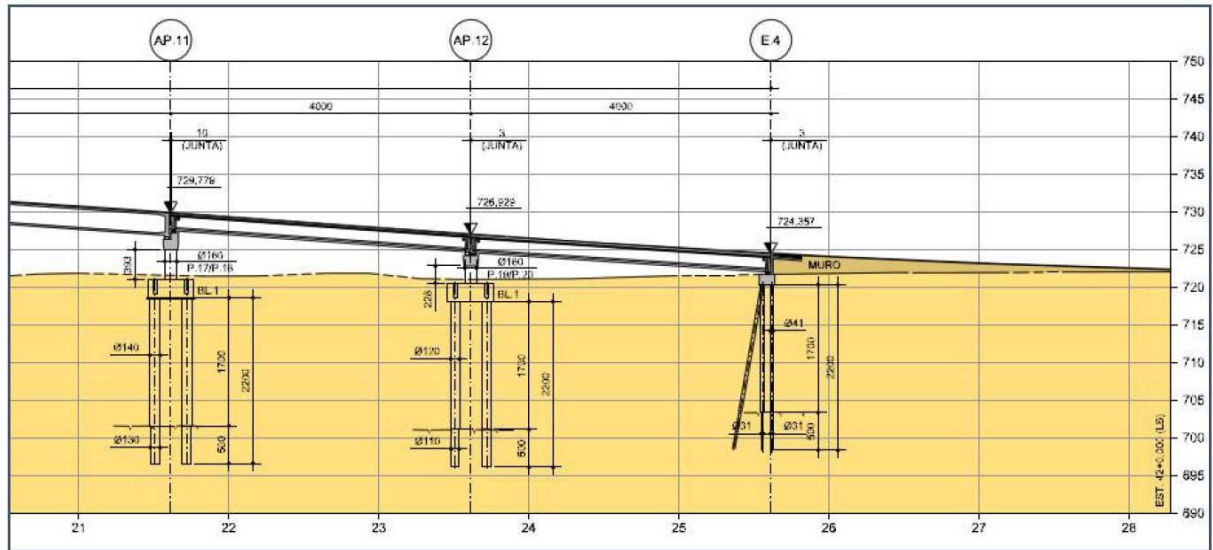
Perfil longitudinal da OAE – pista direita 4/4.
